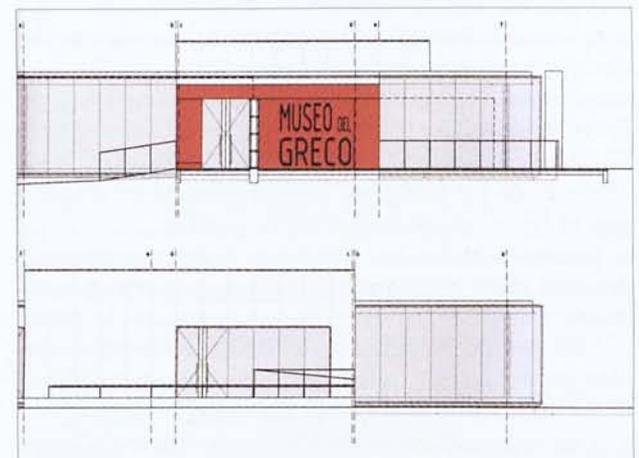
Alzado del futuro acceso al museo. Proyecto: F. Pardo y B. García.
